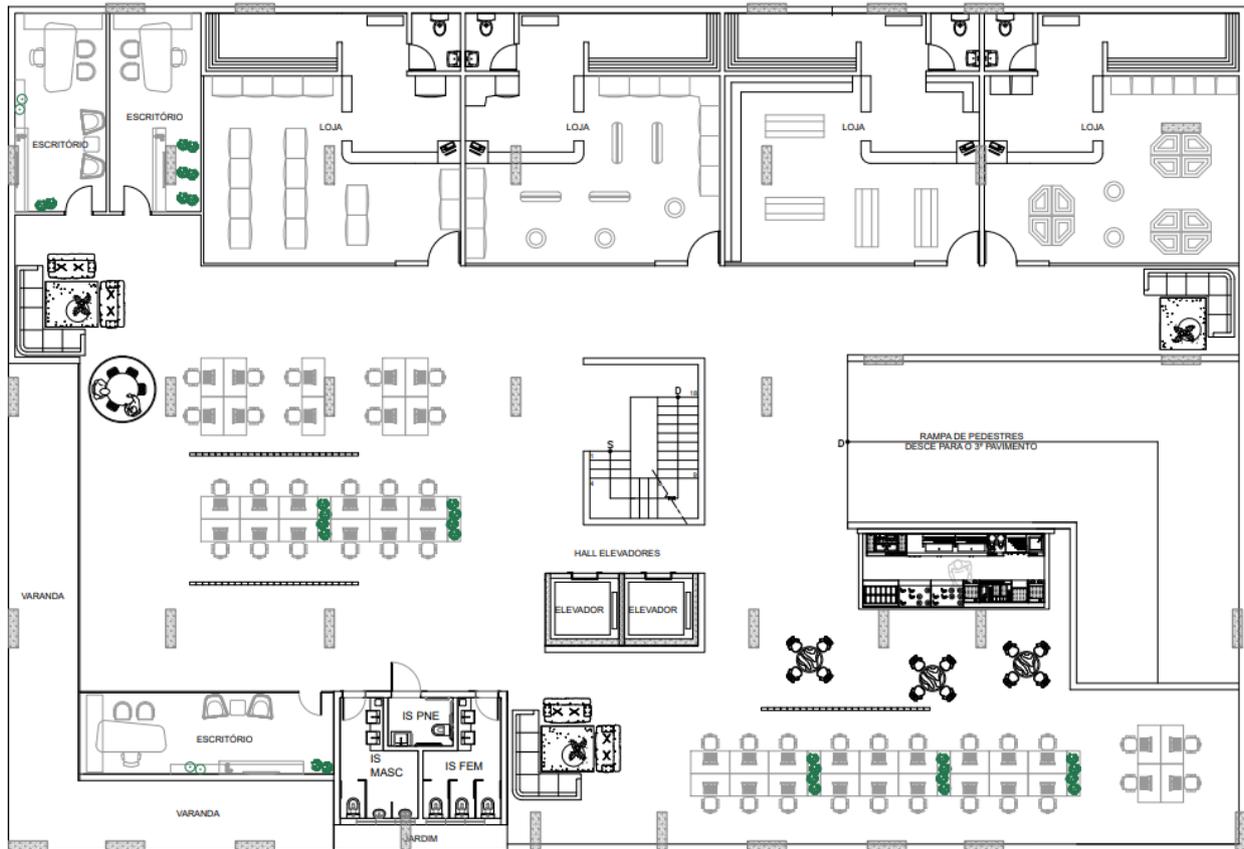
BLOCO COMERCIAL - 4º Pavimento
